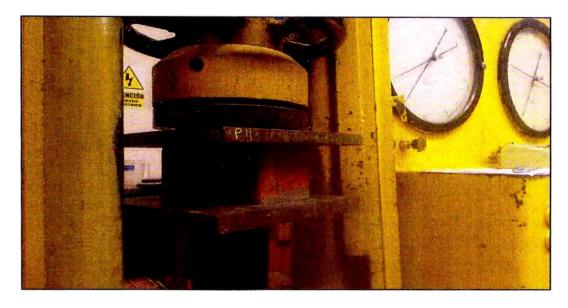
Unidad de albañilería sometida a esfuerzo de compresión axial.
